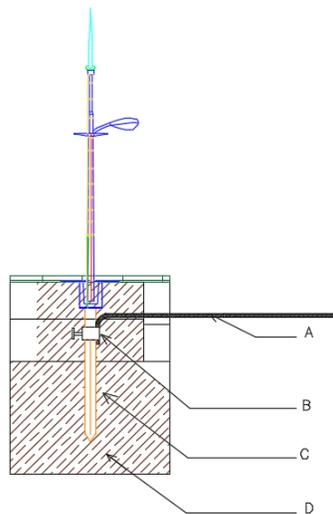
Elementos del sistema de apantallamiento propuesto conexión bajo tierra. Fuente: elaboración propia
